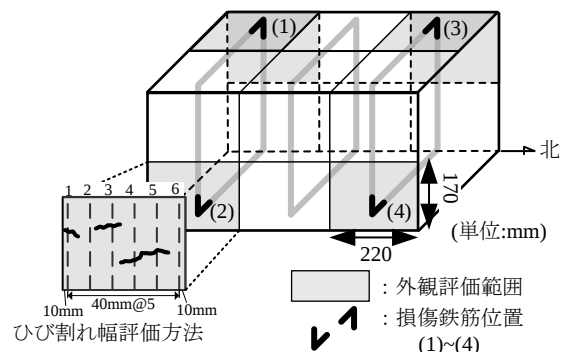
損傷鉄筋周辺のひび割れ評価
